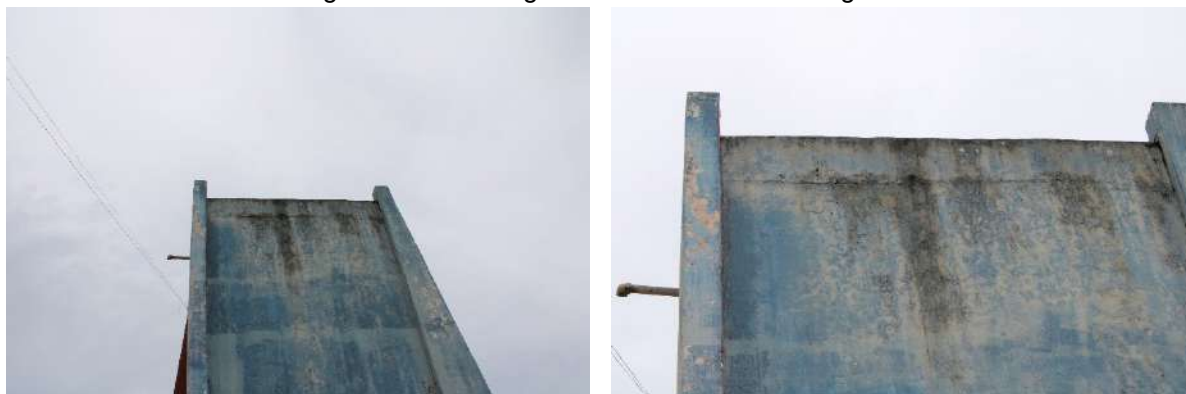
Vistas das estruturas de ventilação do vestiário.
